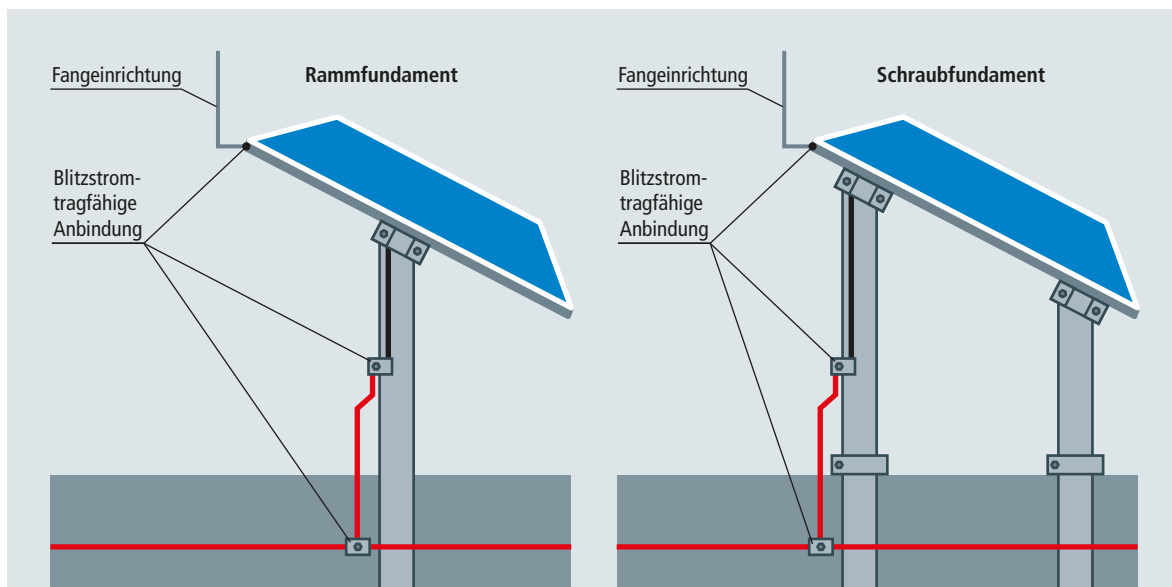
Ramm- und Schraubfundament mit blitzstromtragfähiger Verbindung von Fangrichtung und Erdungsanlage
